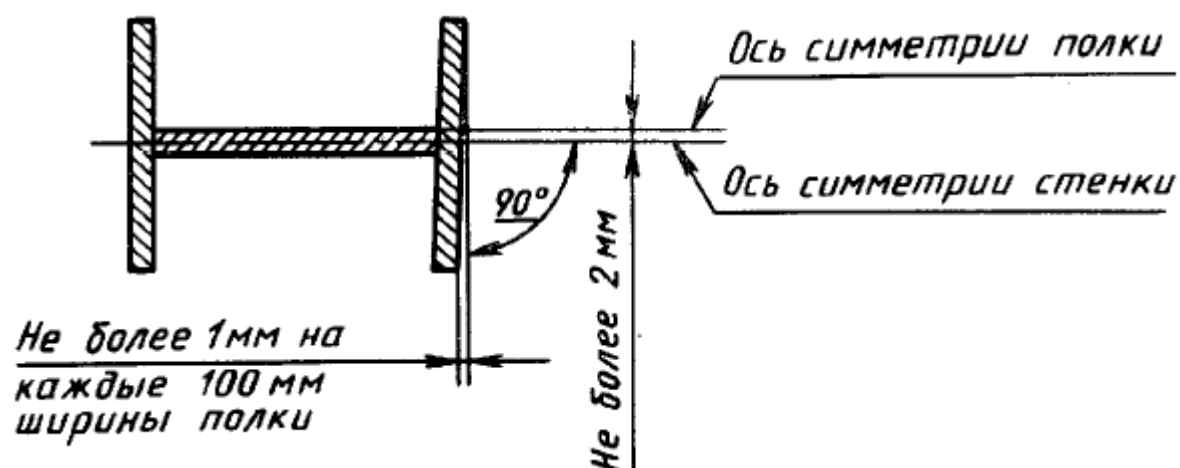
Допуски на сборку двутавровой балки
